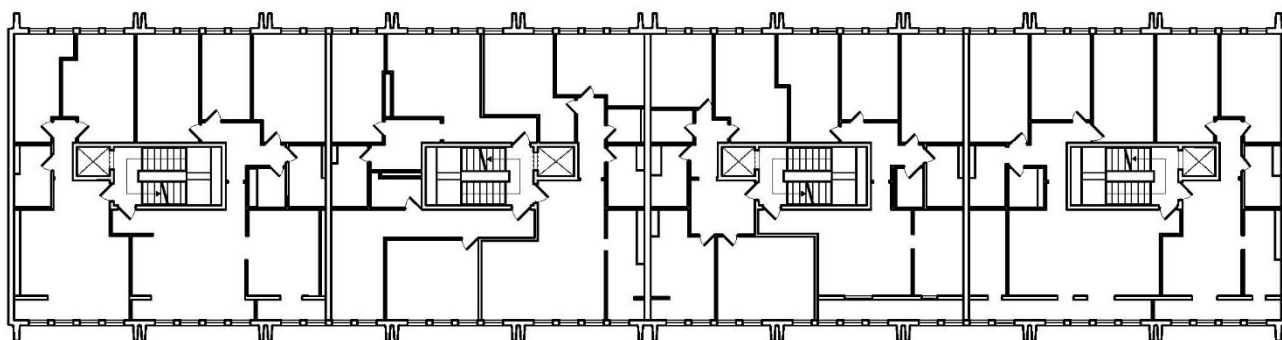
Miniatura pianta piano tipo (nord a sinistra)
